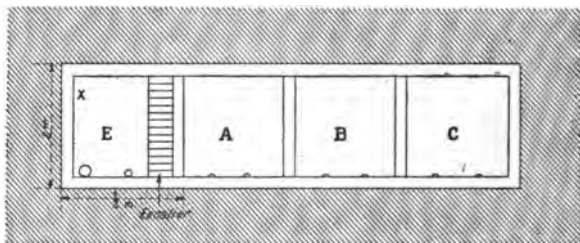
Coupe transversale du puits incliné de la City and Suburban.
